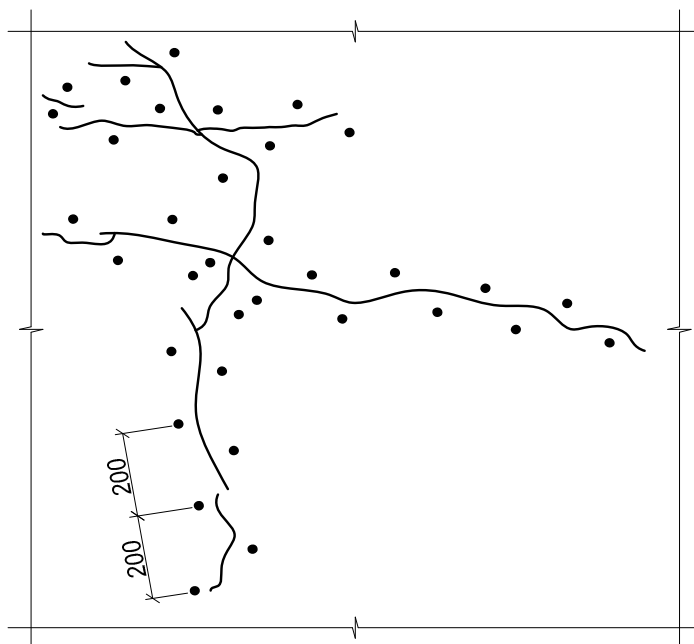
Схема розташування шпурів у залізобетонному перекритті
